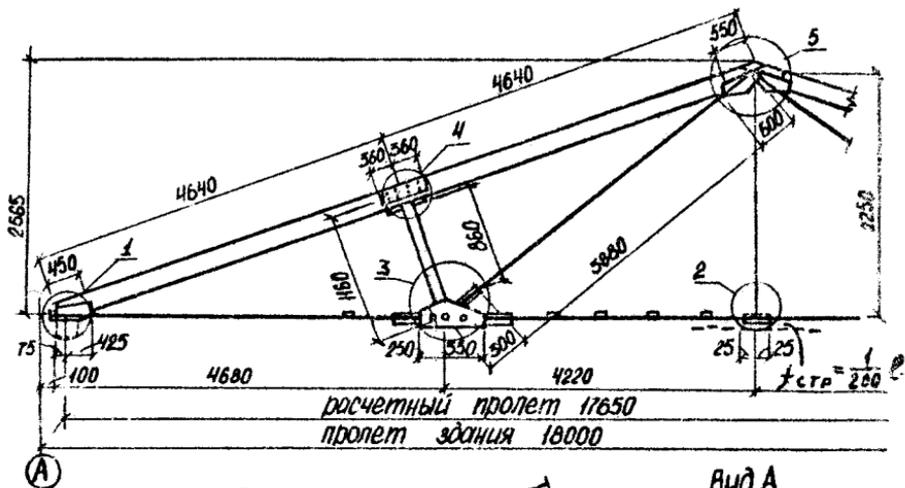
Узлы треугольной дощатой фермы на МЗП:
